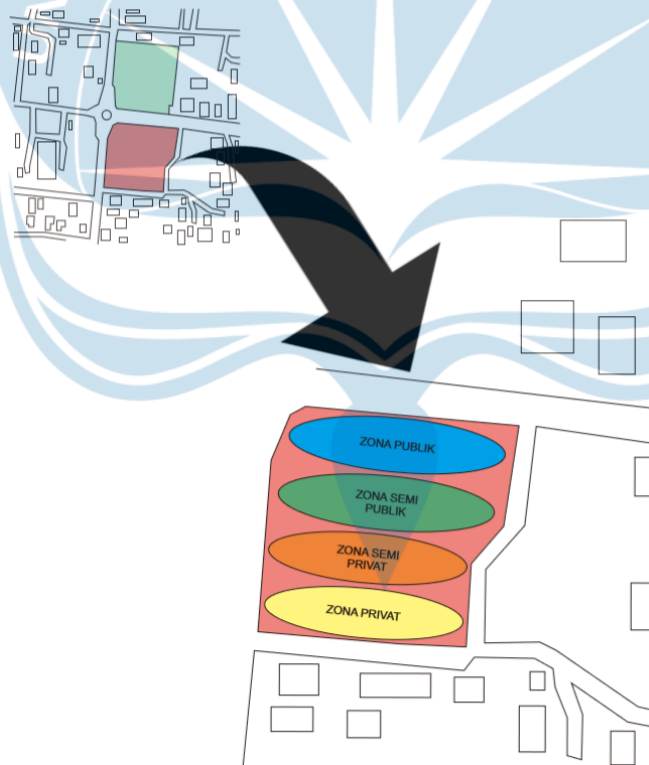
Pencapaian Pola Spiral Pada Site Plan Bangunan
